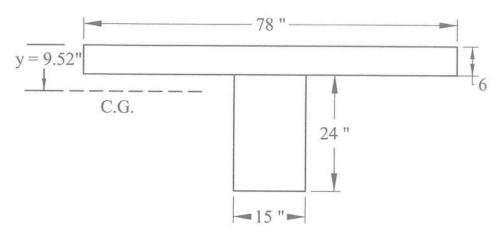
A.5-1 Sección transversal de una viga en T de hormigón: profundidad al centroide de la sección no fisurada
